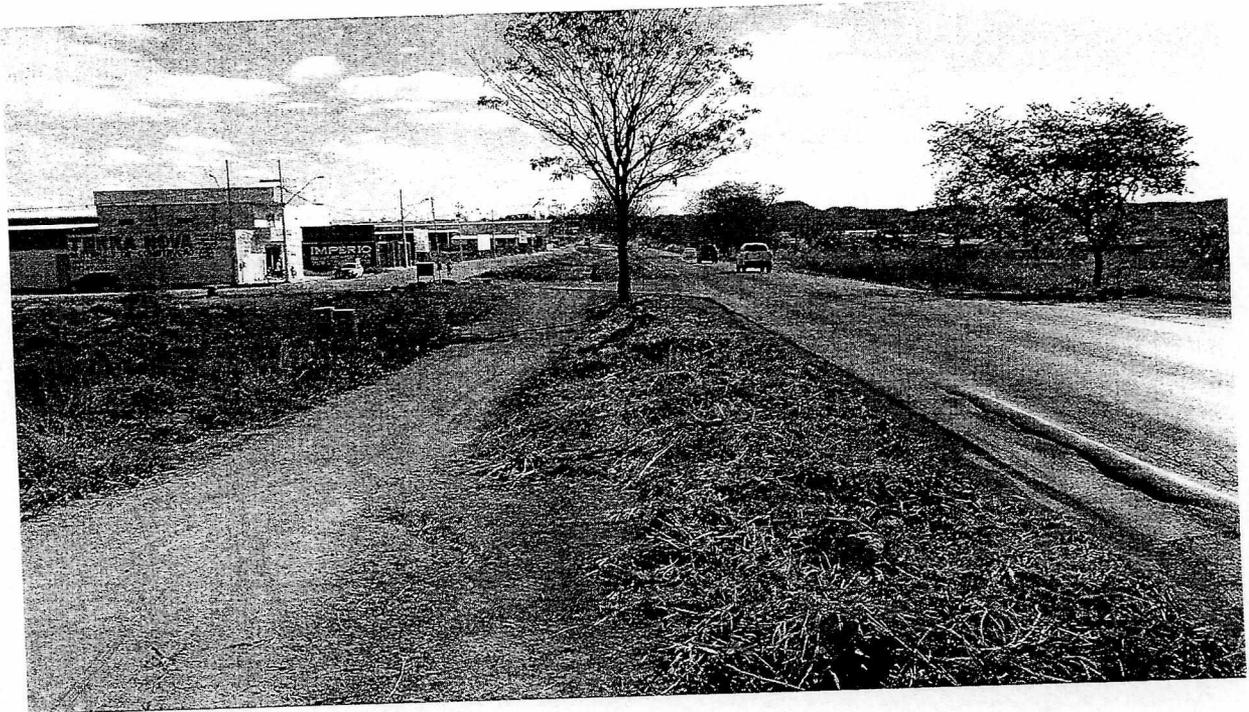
VISTA DA MG 188, ONDE SERÁ FEITA DUPLICAÇÃO DA VIA E CICLOVIA AO LADO ESQUERDO DA PISTA
